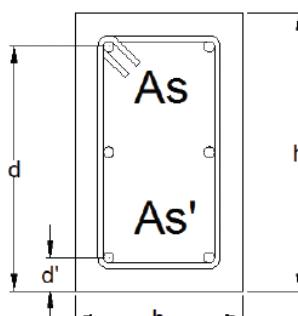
12 Peninjauan Balok Memanjang AS B (5 – 6)
